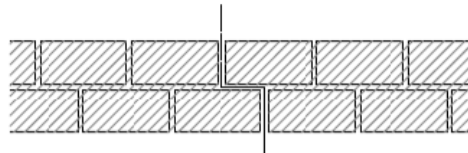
Junta de movimiento con solape. Esquema en planta
